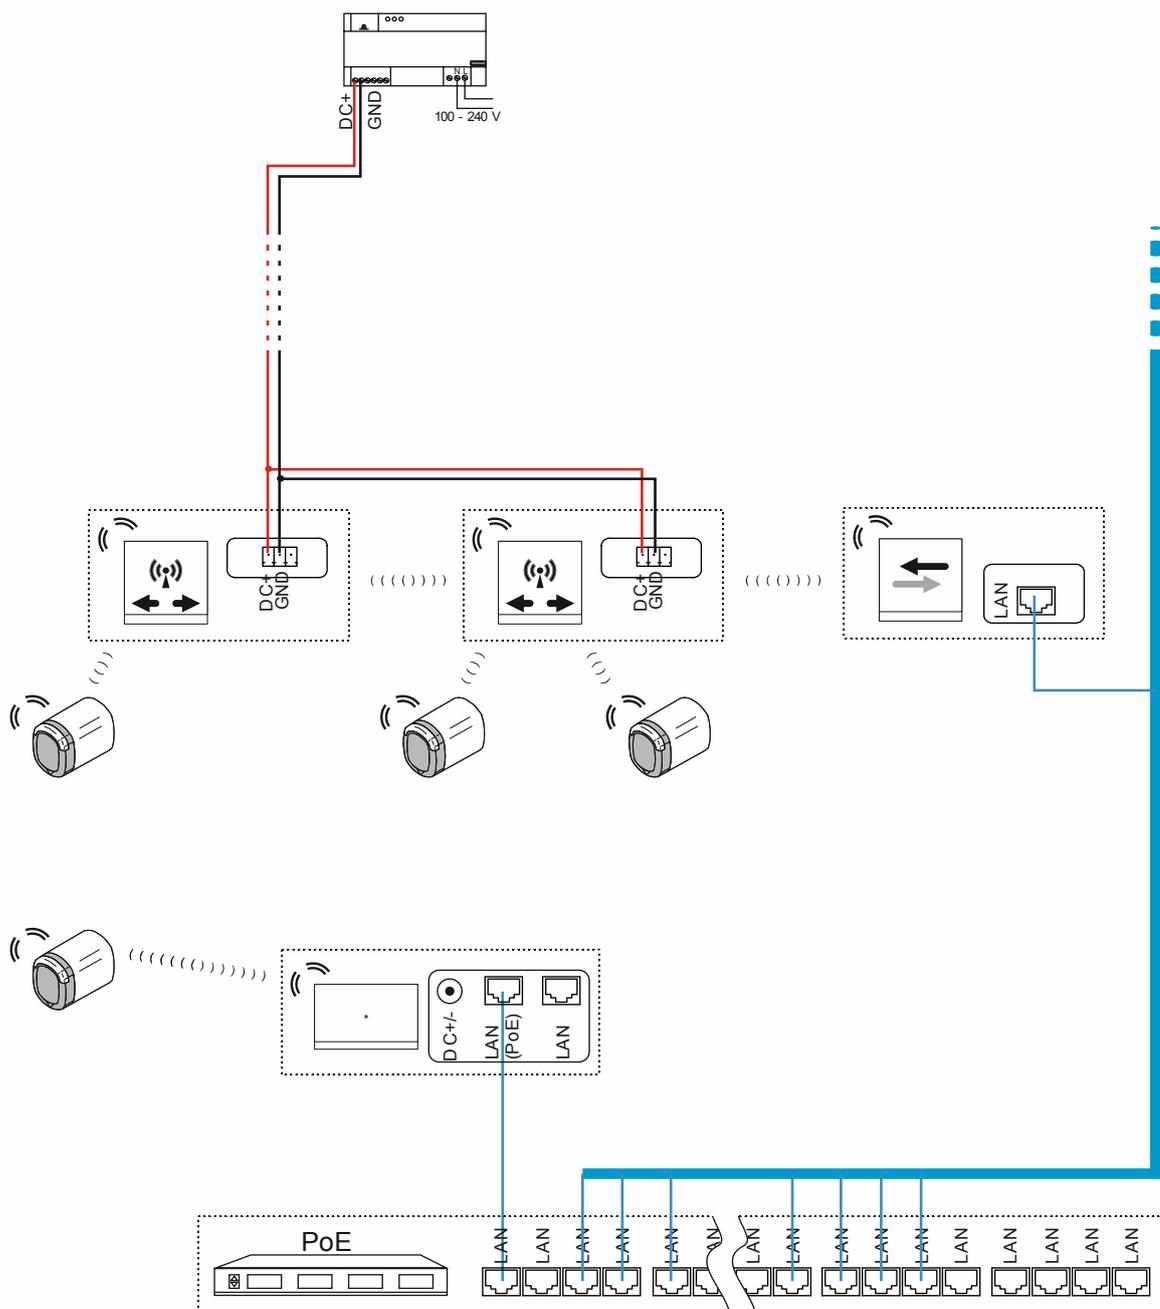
Conexión: edificio de viviendas de varias plantas con más de 10 metros de trayecto de transferencia
